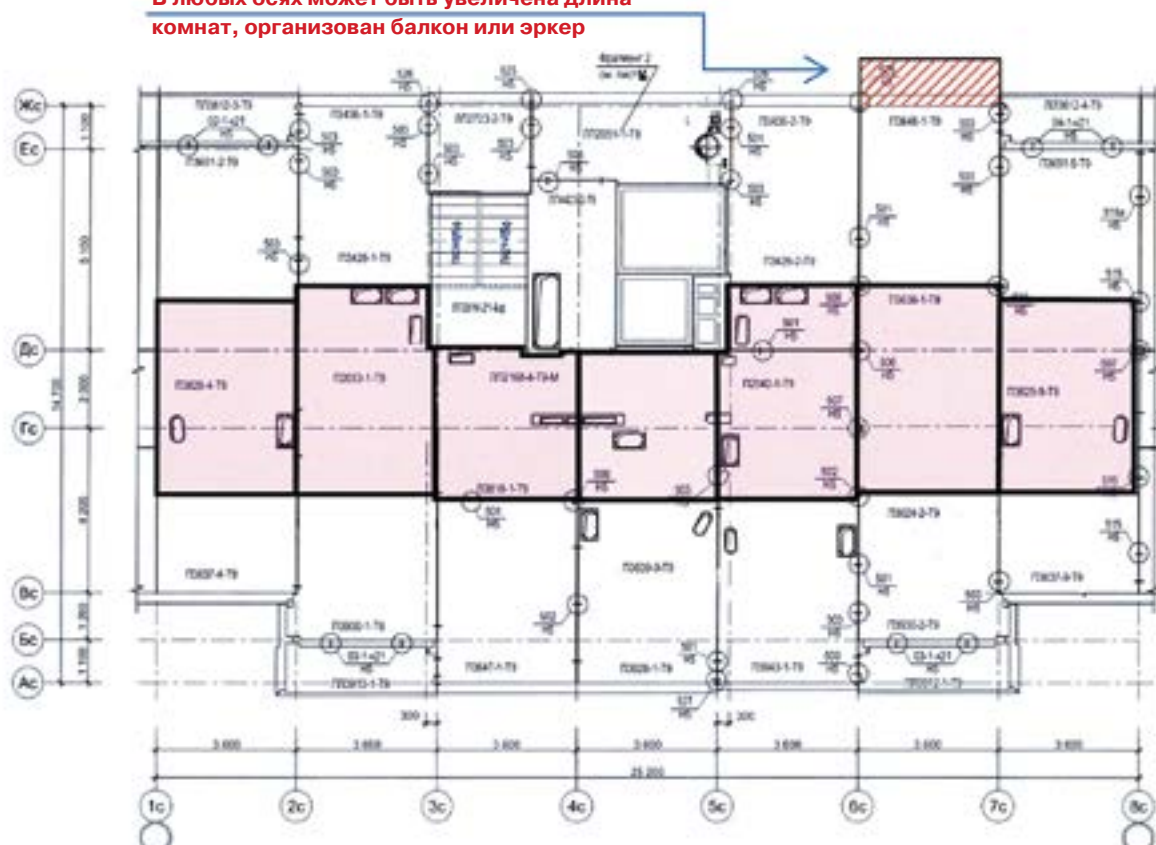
Изменение раскладки плит перекрытия для свободных планировок во всей блок-секции или только в конкретных квартирах
